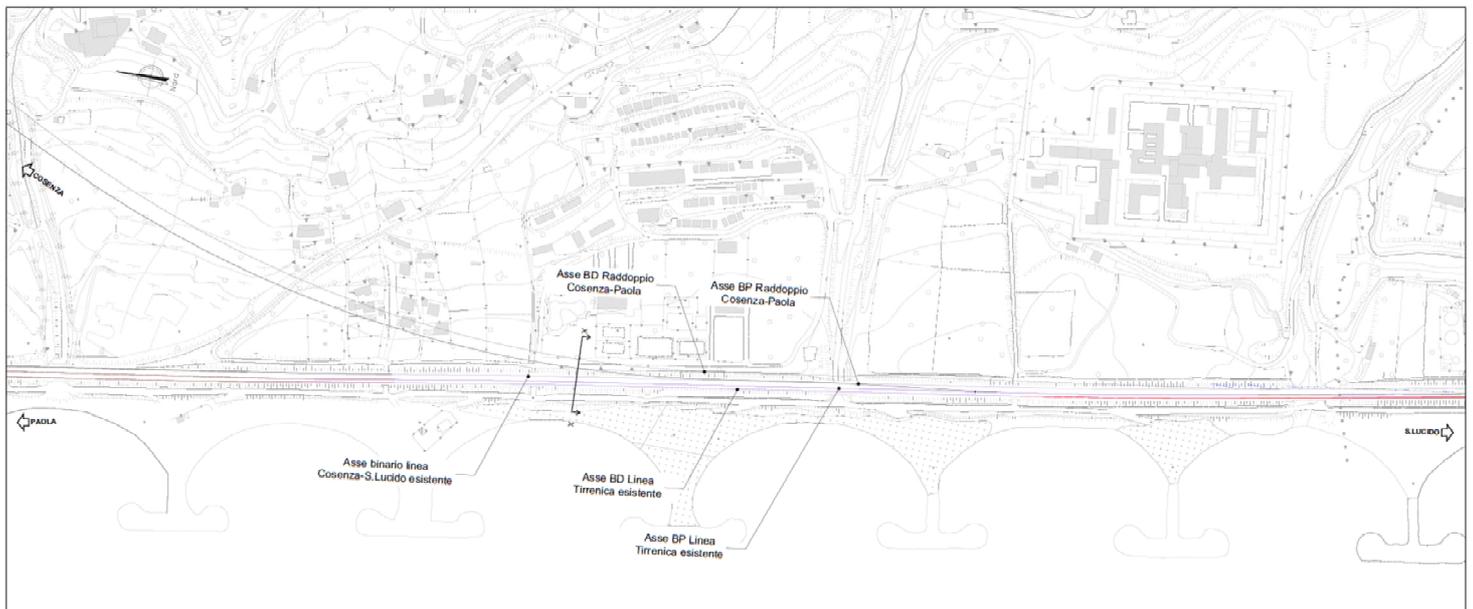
Stralcio planimetrico dell'innesto sulla linea Tirrenica esistente, con individuazione della sezione trasversale studiata (X-X)
